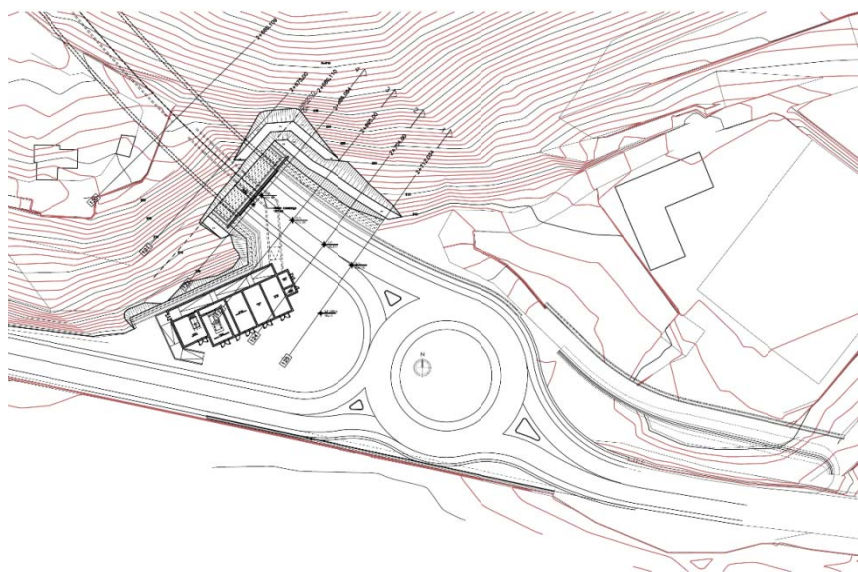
Planimetria generale dell'imbocco lato Verbania a sistemazione ultimata.
